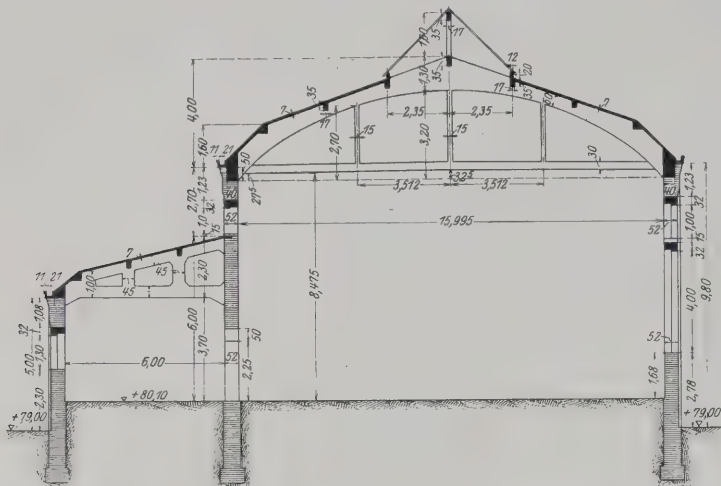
Querschnitt b—b durch das Kauengebäude.
